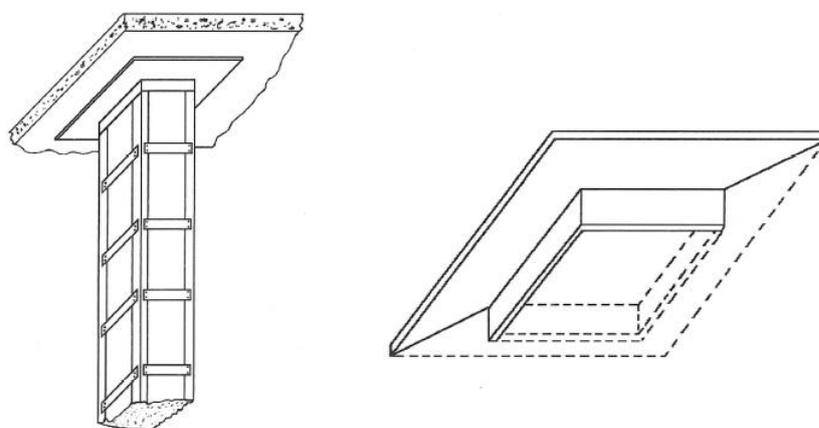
Reforço de pilar de concreto com perfis metálicos e detalhe do capitel .
